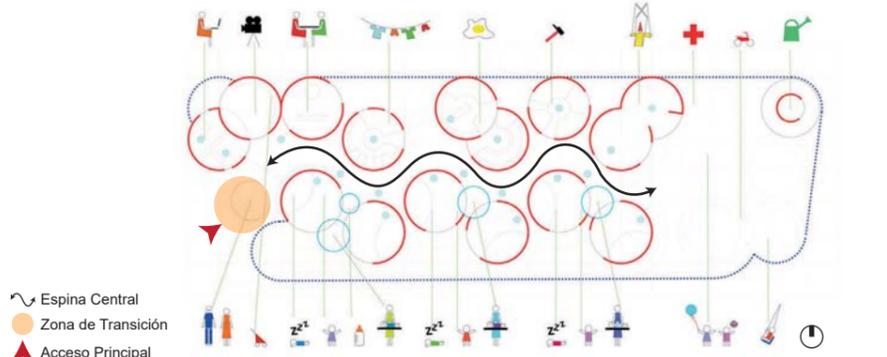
Planta. GA. Guardería de 0/3 años en Arganda. Tomado de (Pizado y de Blas, 2007)
